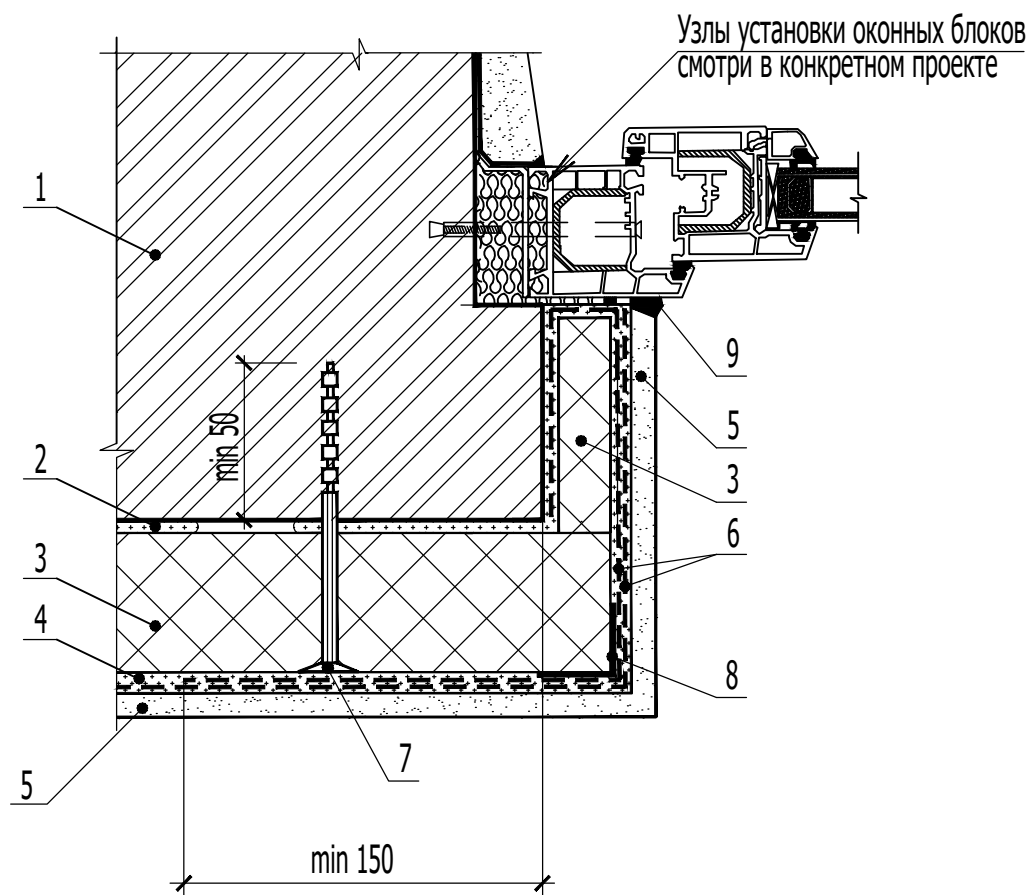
Узел отделки не утепленного бокового откоса окна панельного здания
